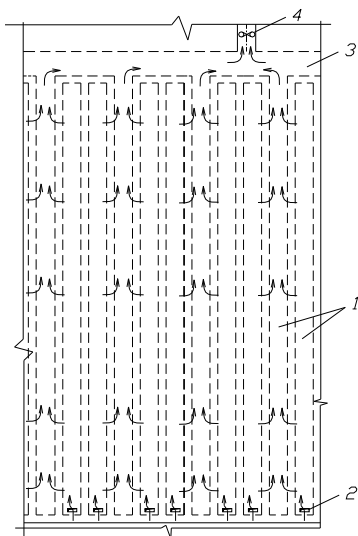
Схема принудительно вентилируемой наружной стены:
